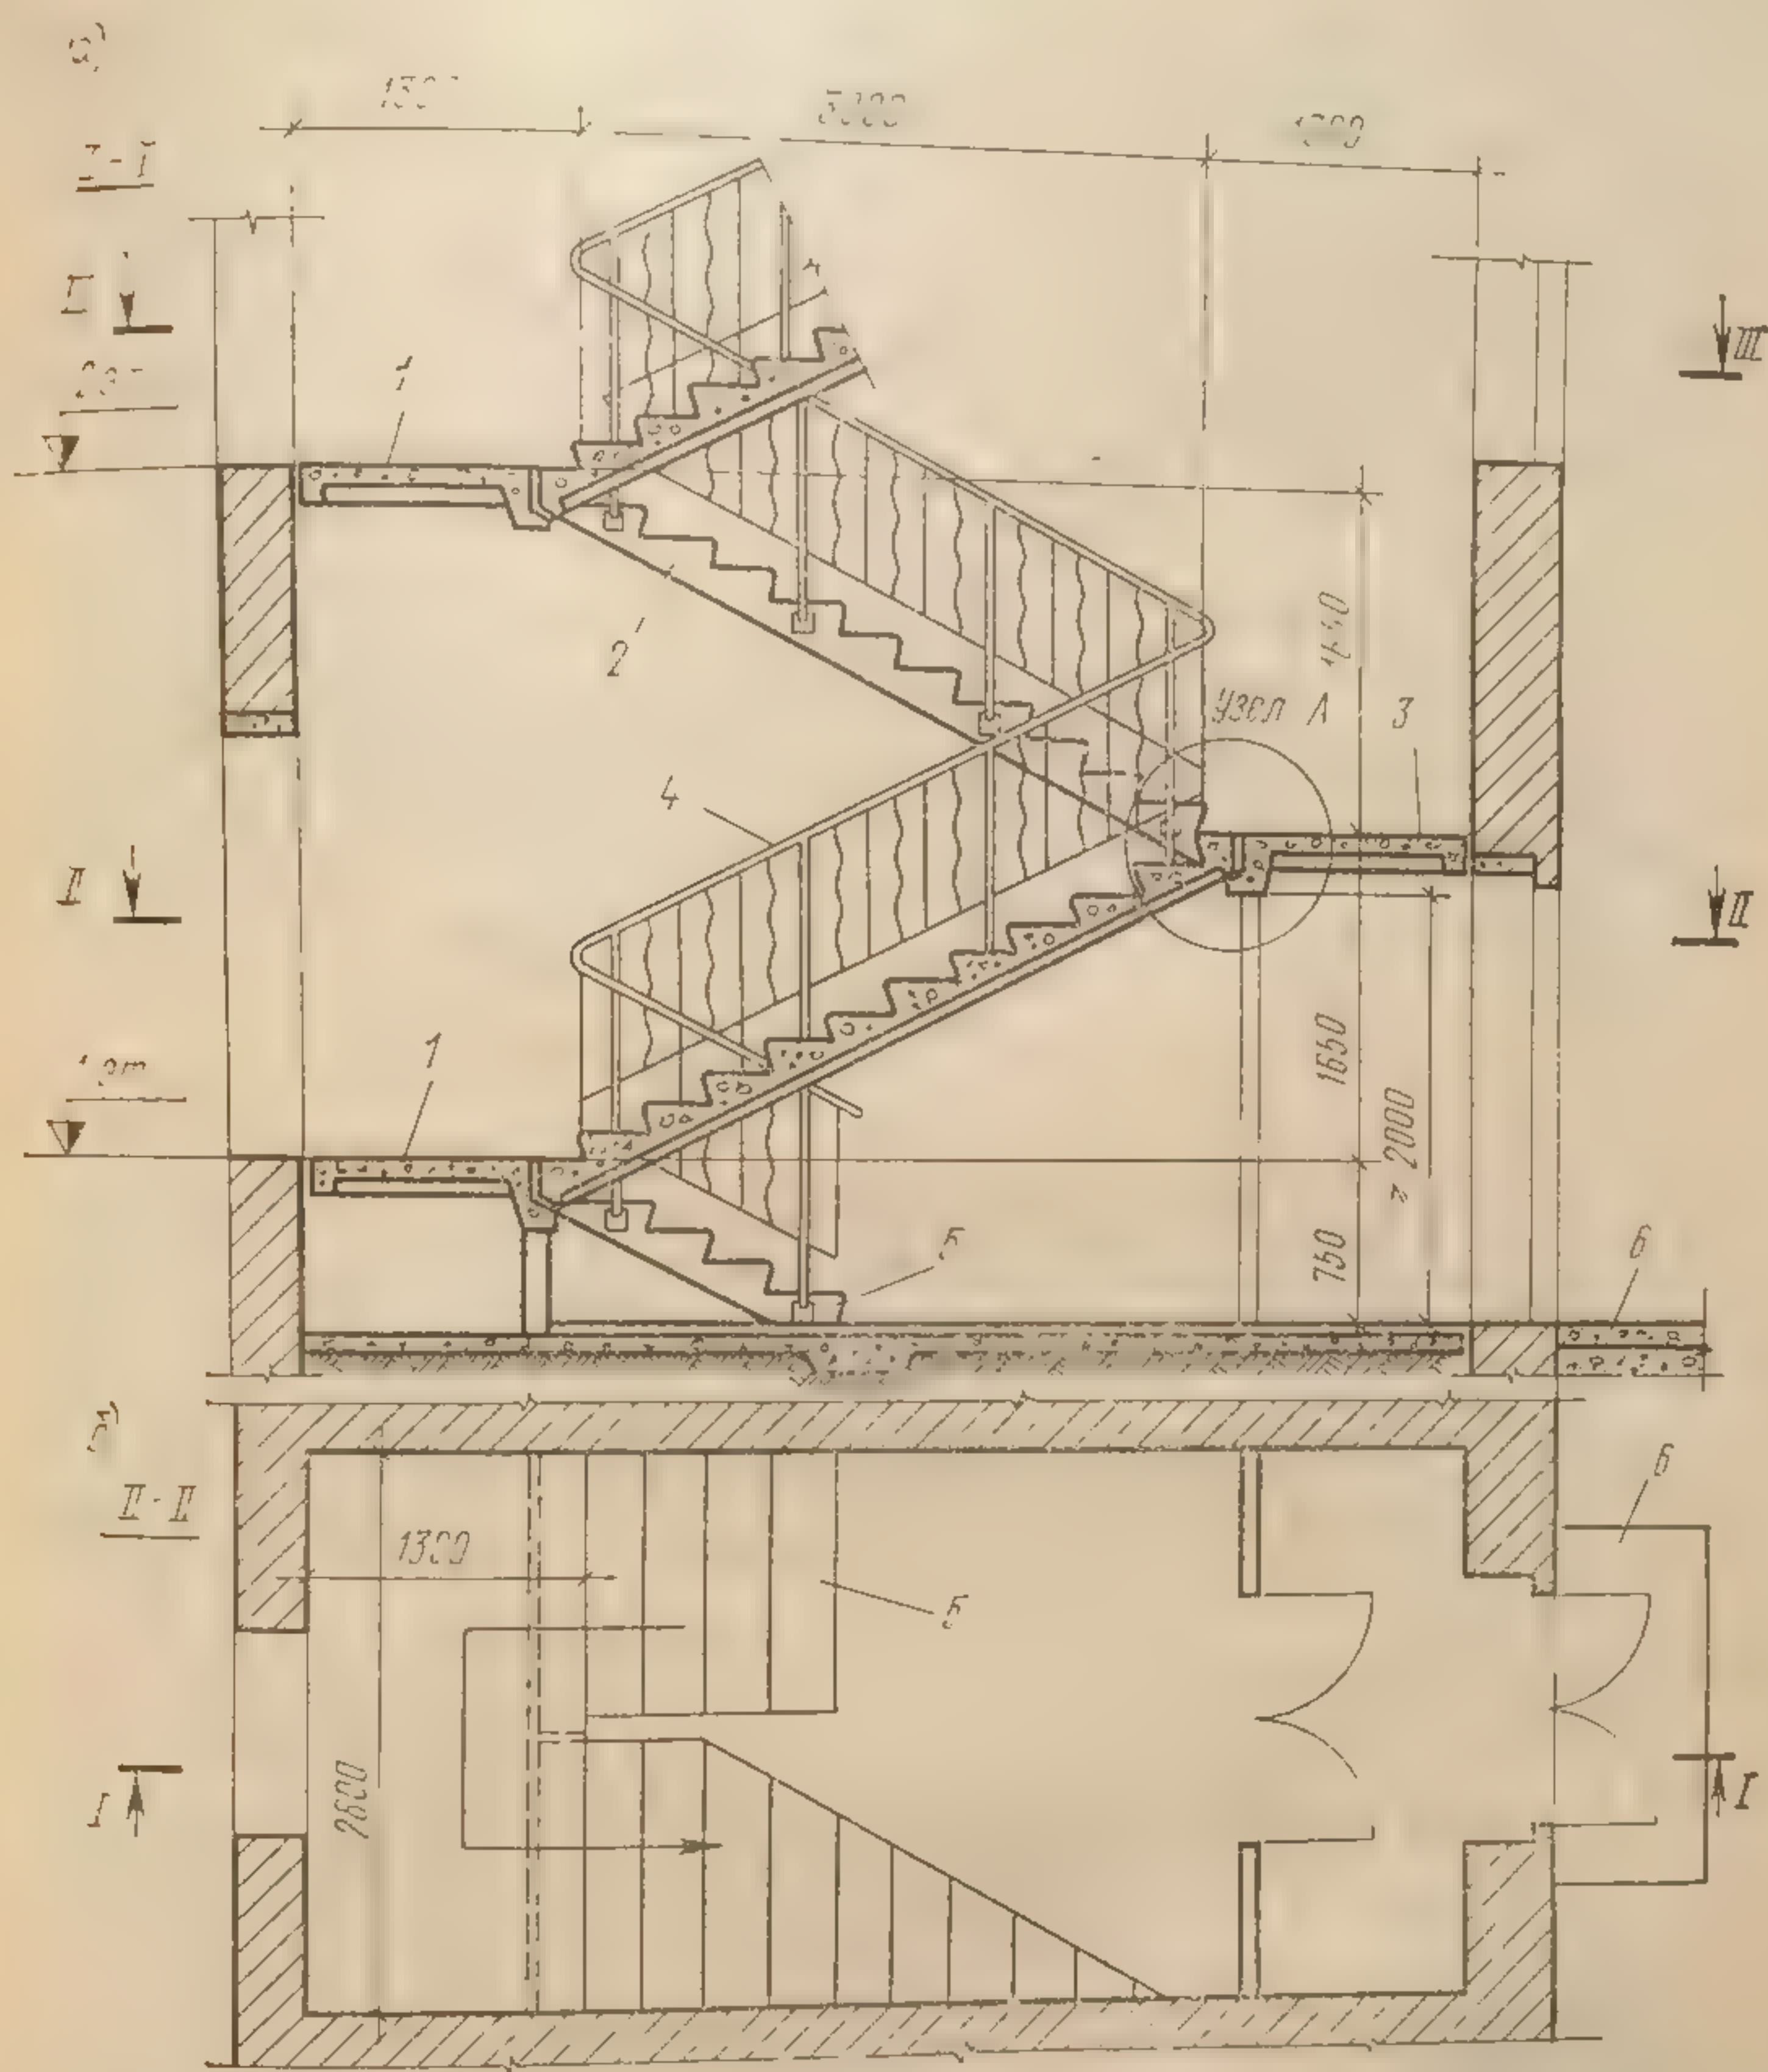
Двухмаршевая лестница из сборных железобетонных маршей и площадок:
